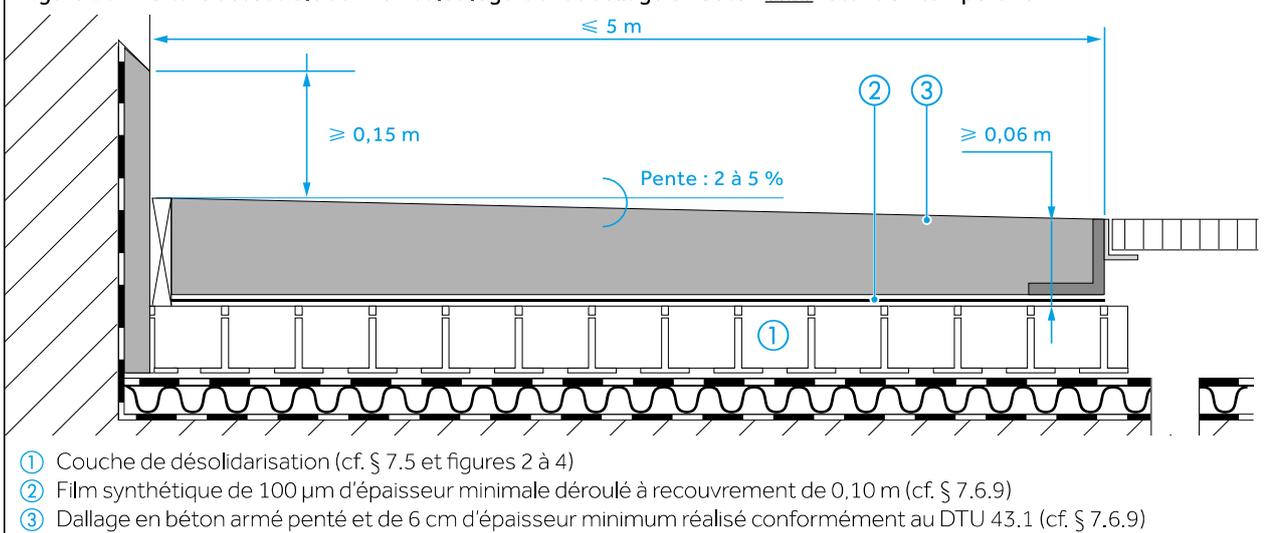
Toiture accessible aux véhicules légers avec dallage en béton avec rétention temporaire
